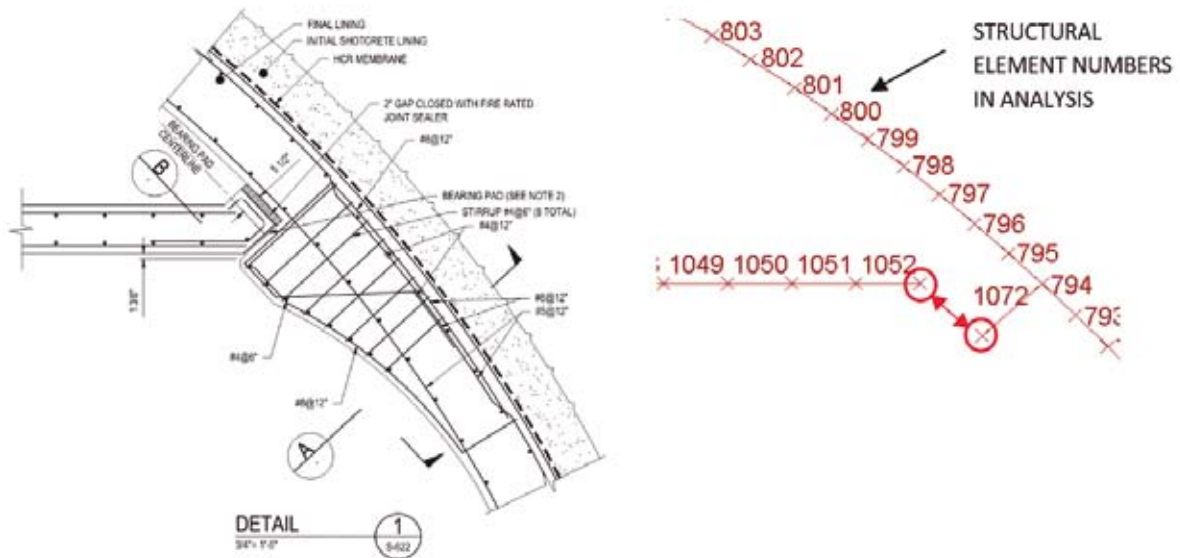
\_ Detalle de apoyo de la losa de ventilación en ménsula inclinada
